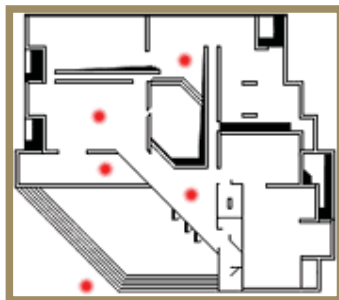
Planta arquitectónica del museo Rufino Tamayo.
